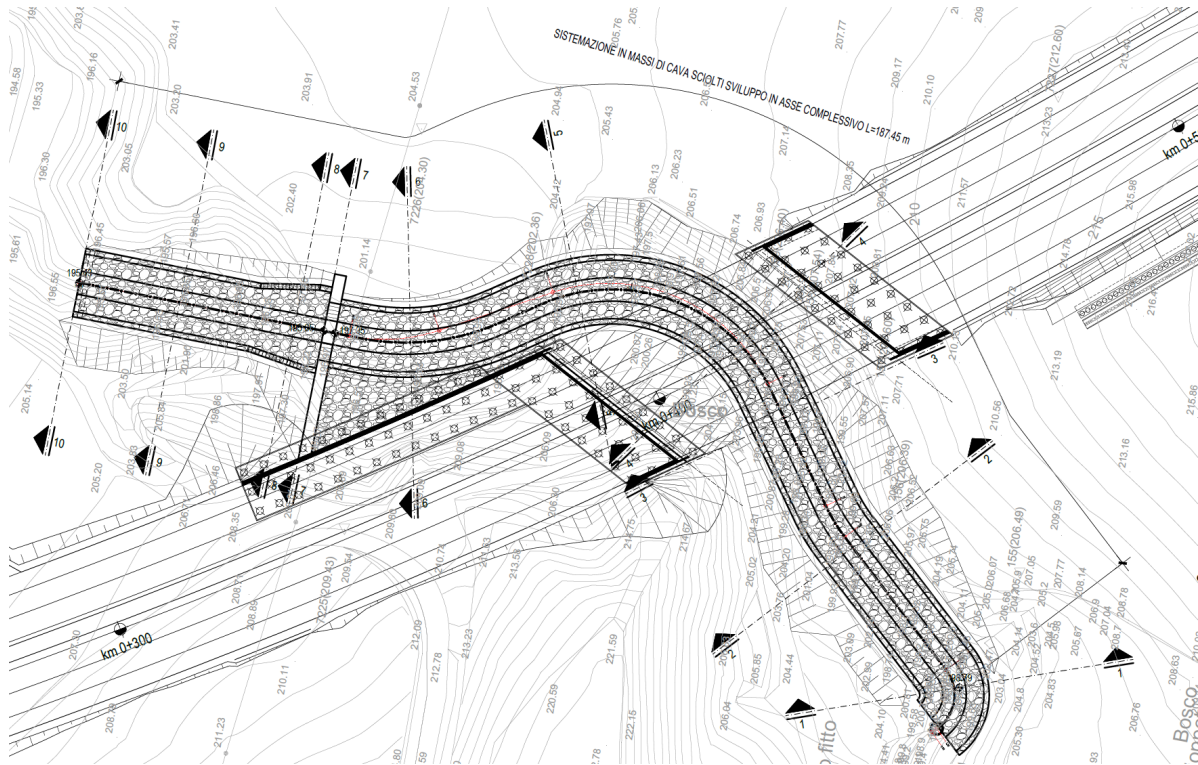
Planimetria di intervento sul Rio dei Deglia
